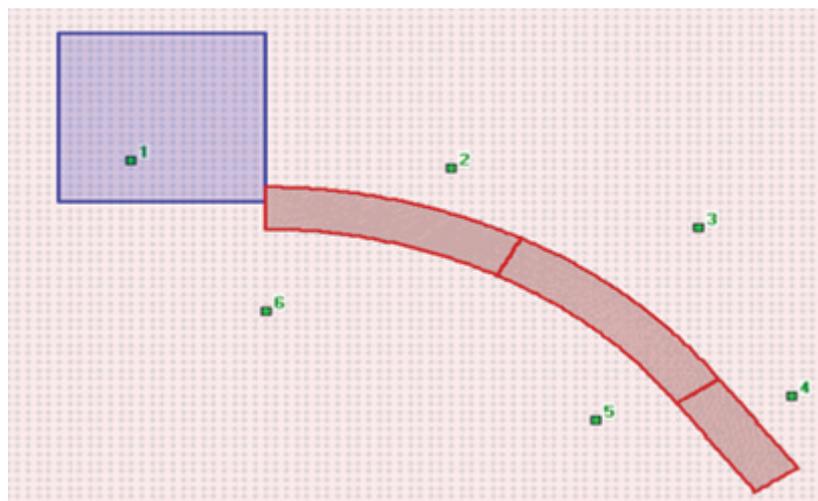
К моделированию грунтового основания под фундаментной плитой подпорных стен
